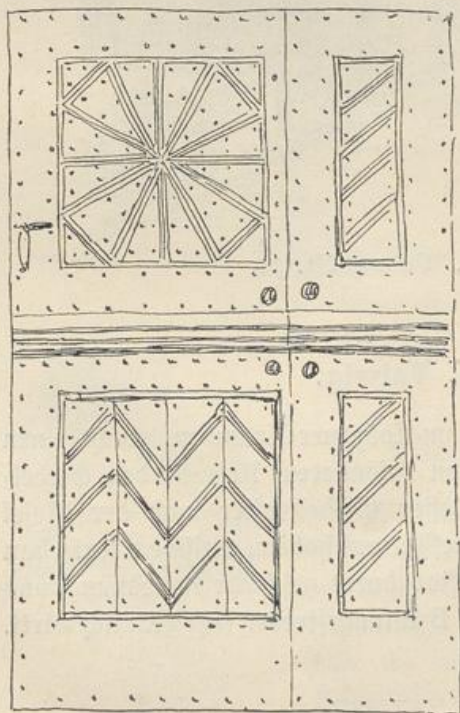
Steeg, Pilger'sches Haus an der Kirche.
